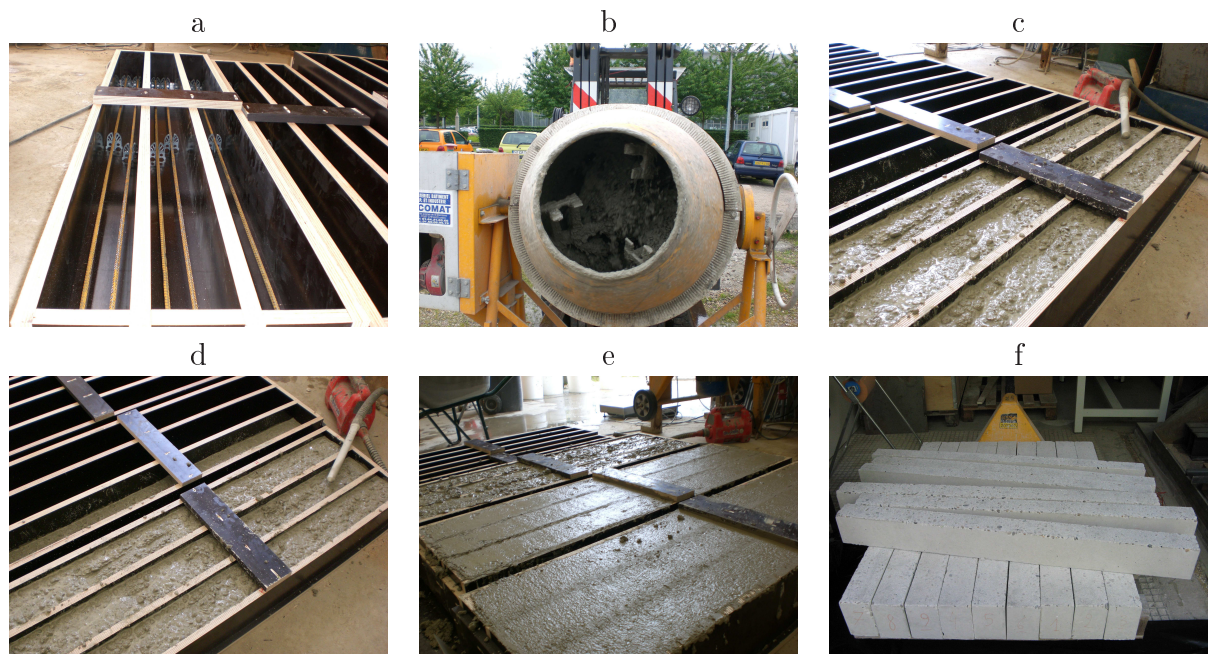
Étapes de la réalisation des poutres : a) coffrage et ferraillage b) préparation du béton c) coulage du béton d) vibration e) lissage de la surface f) décoffrage
